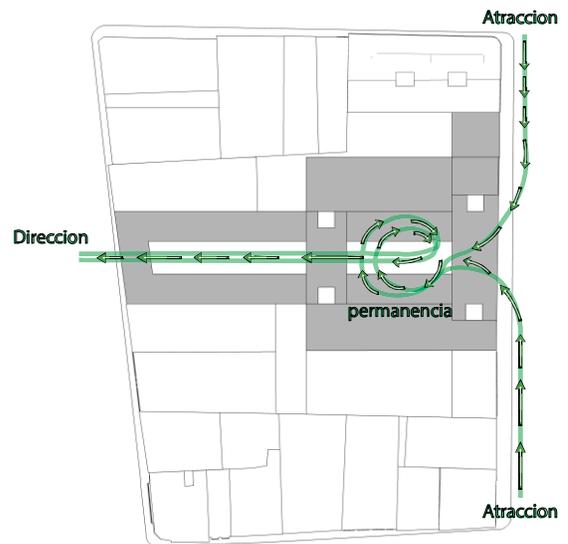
, Implementación de conceptos, vista en planta, realizado en sketchup, nov 2016, Elaboración propia
